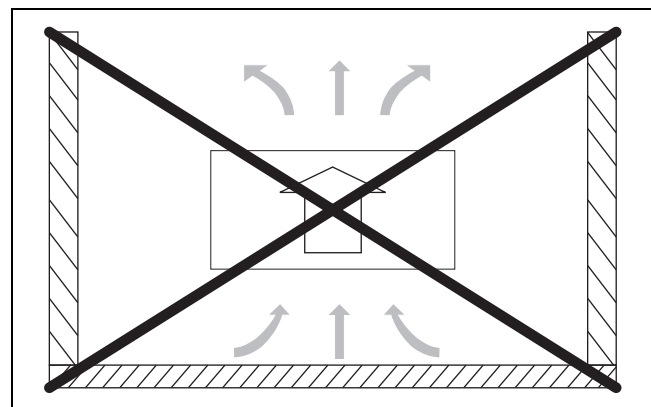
Не устанавливайте тепловой насос в окружении стен
